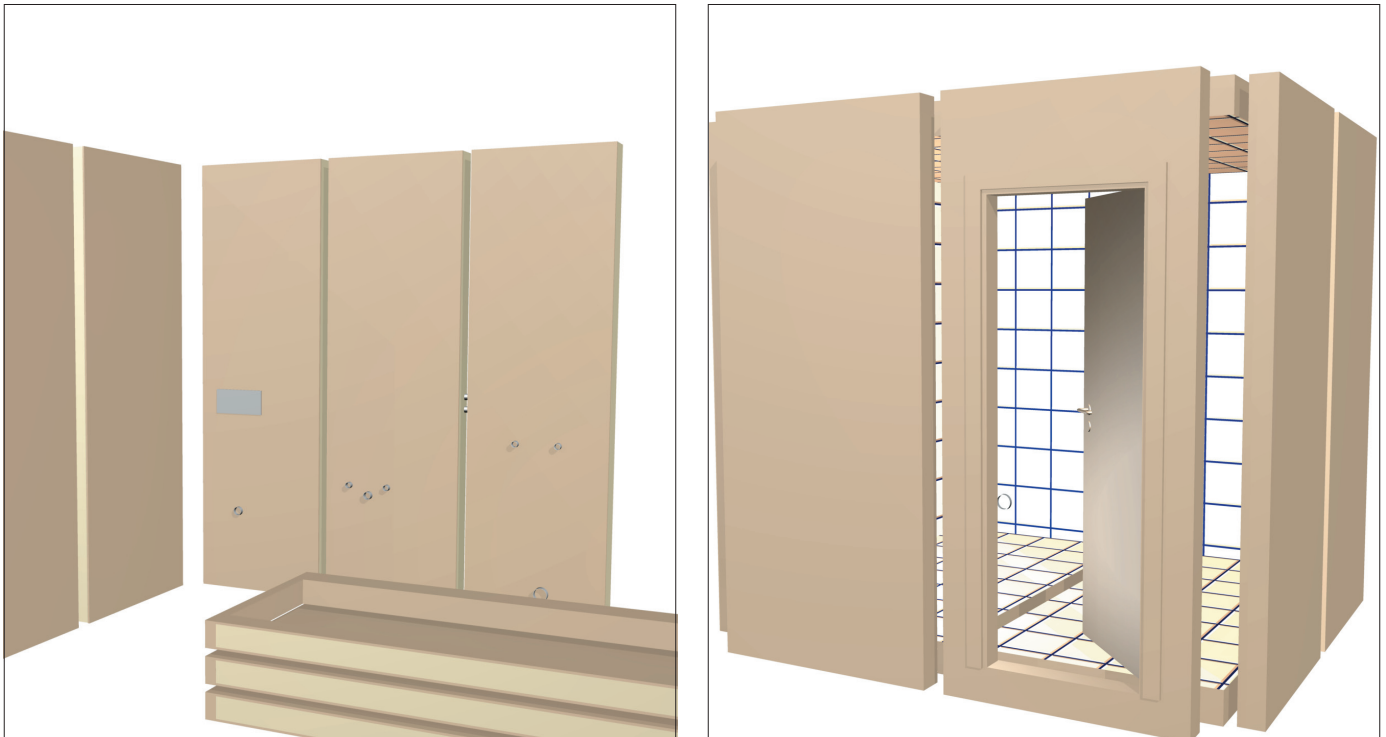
Elementierte Sanitärzellen bestehen aus einzelnen Wand-, Decken- und Bodenpaneelen, die bereits vorgefertigt alle Leitungen, Anschlüsse, Sanitärkomponenten, Halterungen und Befestigungen enthalten. Diese raumhohen Paneele können gedämmte Holzständerwände, Metall-Sandwich-Elemente, Blätton-Elemente oder glasfaserverstärkte Kunststoff-Verbund-Elemente sein. Sie werden einzeln auf die Baustelle transportiert und dort aufgestellt, verbunden und angeschlossen. Es ist möglich, schon im Werk das Oberflächenfinish fertig herzustellen oder die Elemente auf der Baustelle zu fliesen
